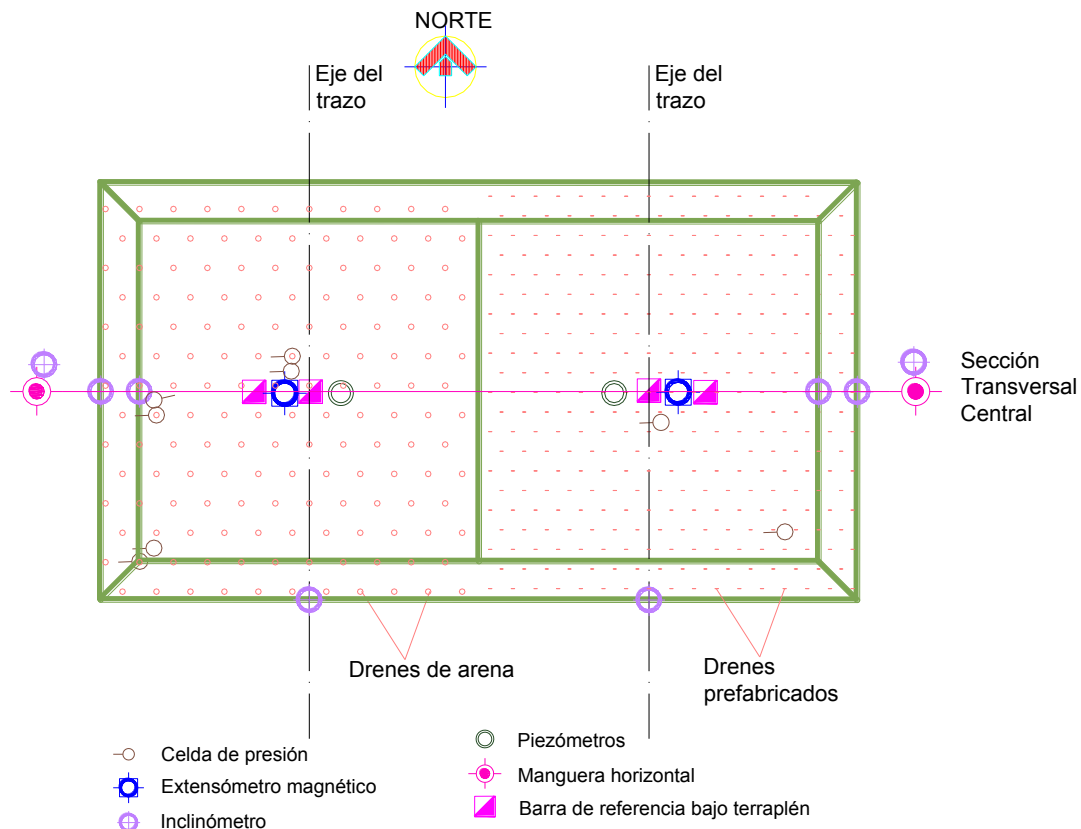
k.5 Esquema en planta de la instrumentación del terraplén con drenes y precarga
